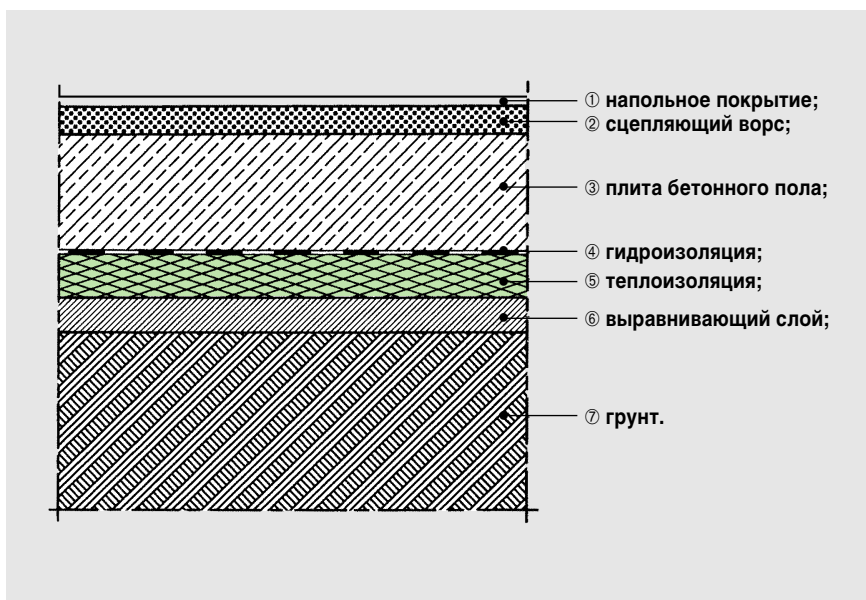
Несущее внутреннее перекрытие помещения с расположенным внизу теплоизоляционным слоем, граничащим с грунтом.
